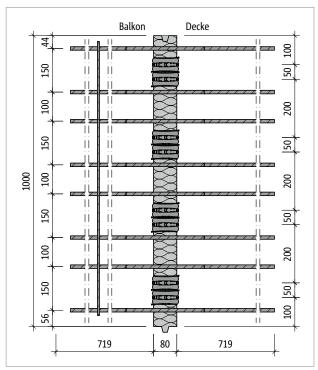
Schöck Isokorb® T Typ QL-V1: Produktgrundriss
